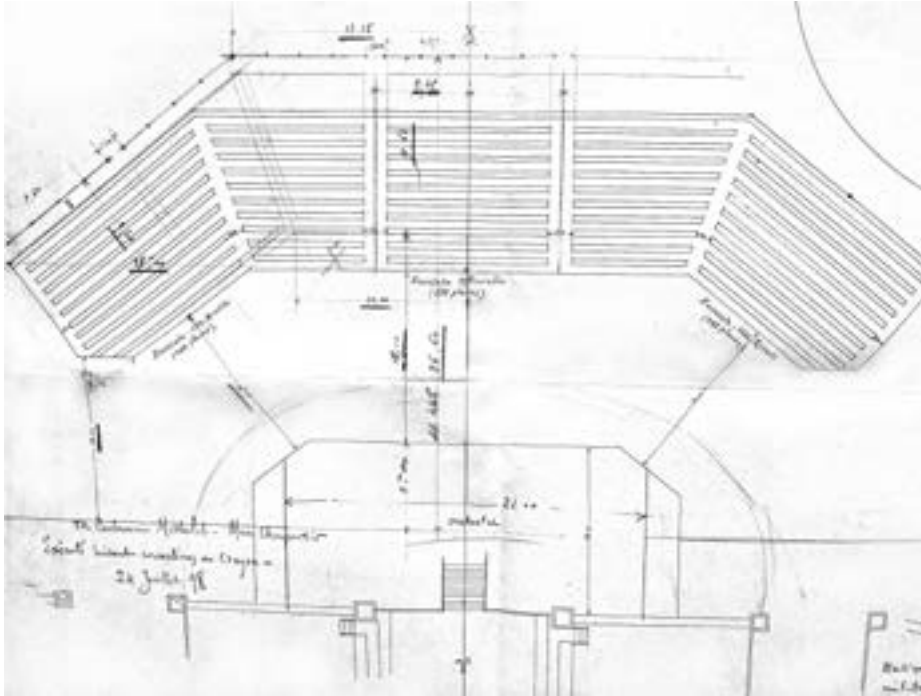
Plan de la place de l'Hôtel de Ville pour la fête publique du 24 juillet 1898.
